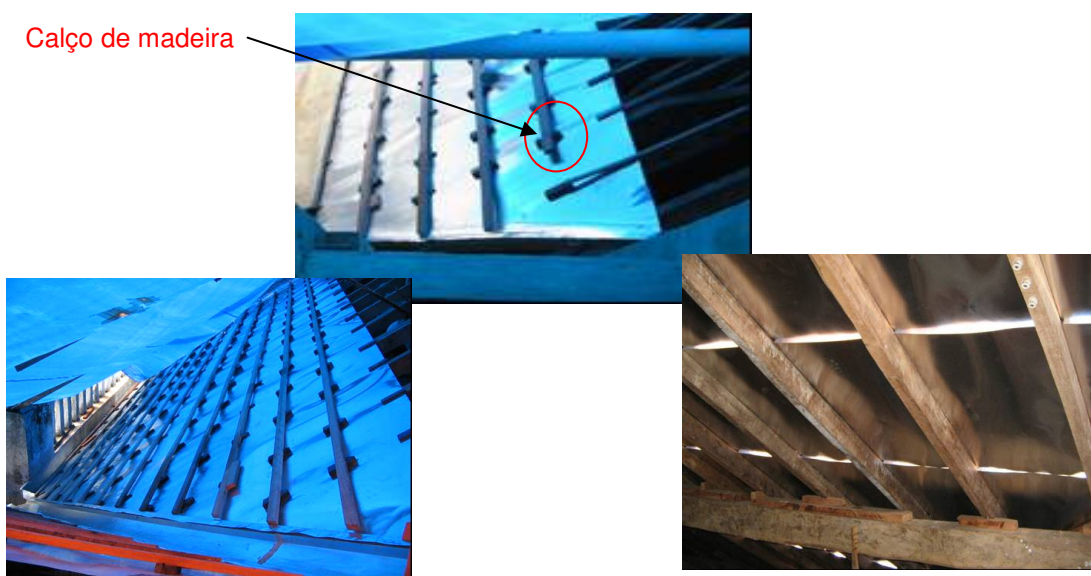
Visualização da manta metálica. Calços e ripamento que intercalam a estrutura do telhado
